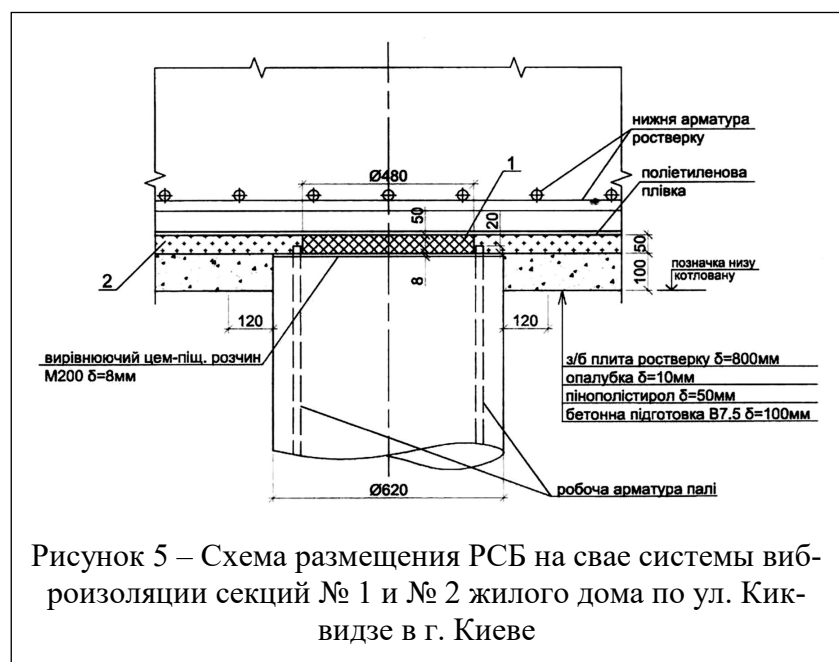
Схема размещения РСБ на свае системы виброизоляции секций № 1 и № 2 жилого дома по ул. Киквидзе в г. Киеве
